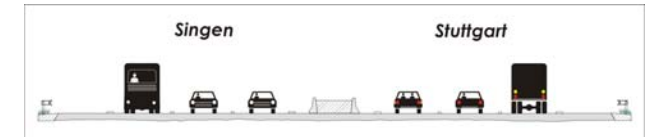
Querschnitt der Fahrbahn nach dem Ausbau
